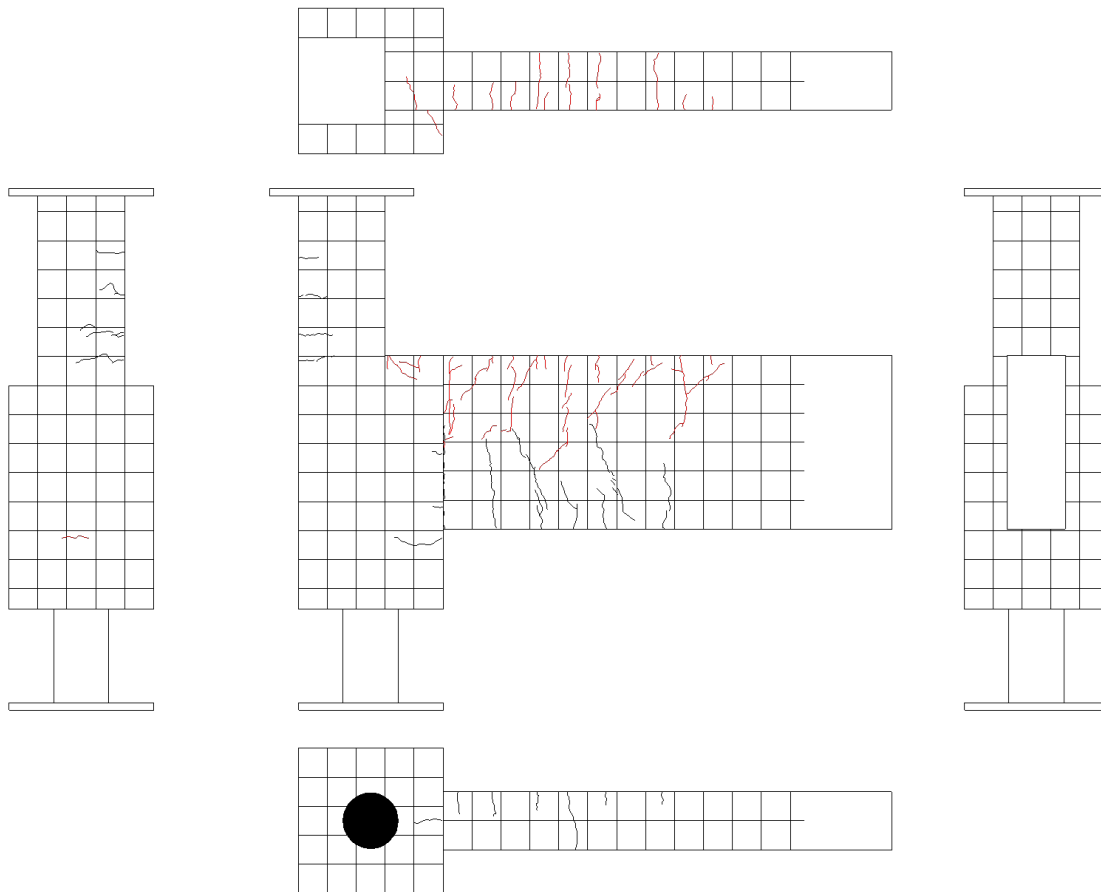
試験体 C-1 ひび割れ状況 (10Cycle)
